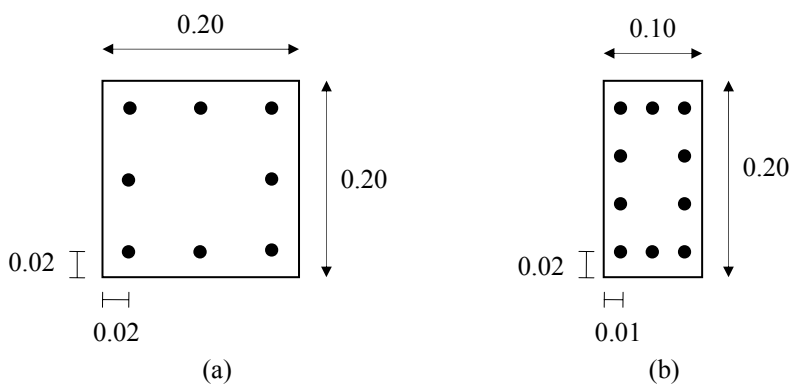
Sección transversal tipo. Distribución de armadura doblemente simétrica uniformemente distribuida en los cuatro lados.
